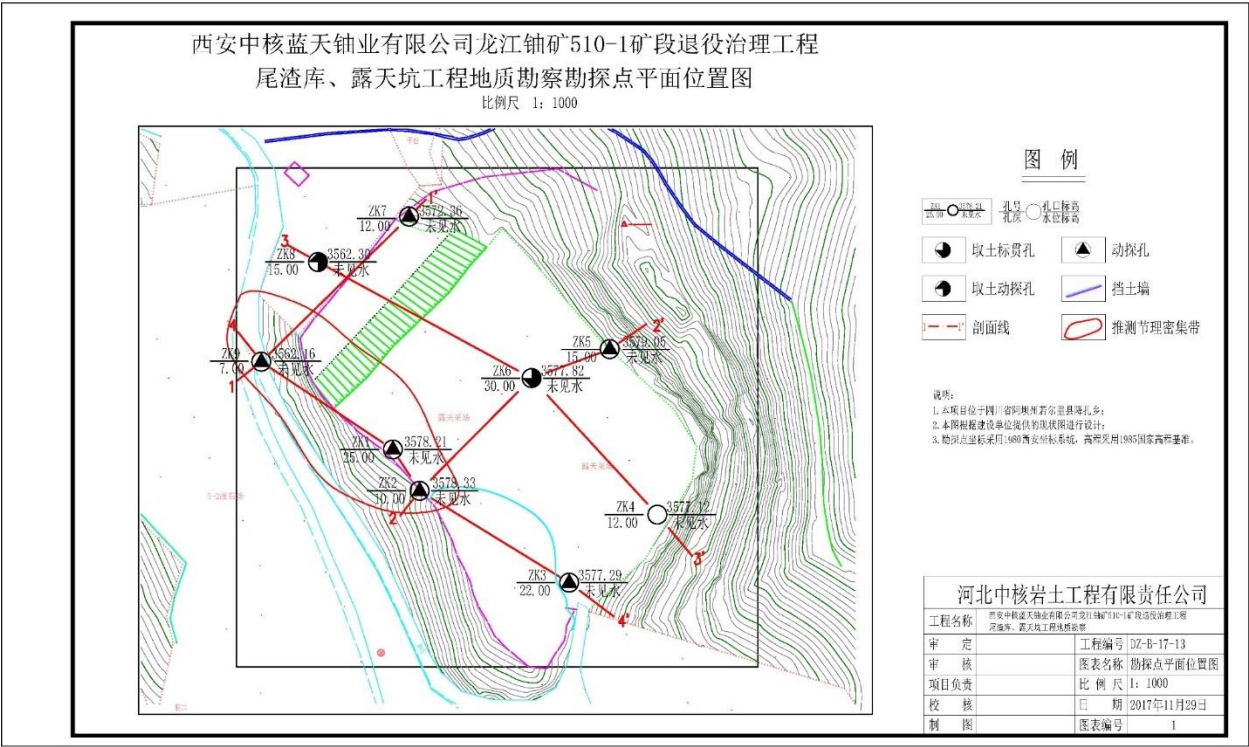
104 露天坑尾渣库工程勘察平面图
